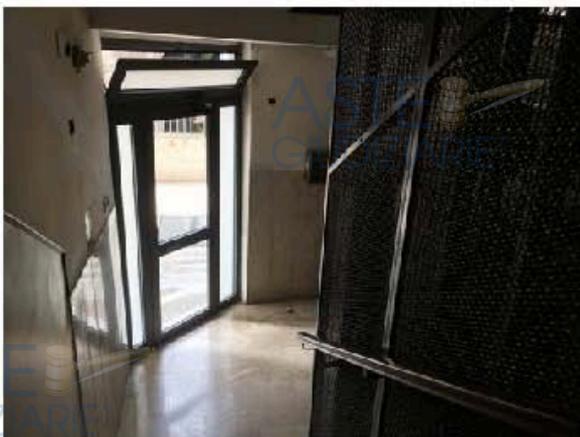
, 6 - Interna del piccolo androne condominiale. Controcampo con indicata la rampa di accesso al piano cantinato
